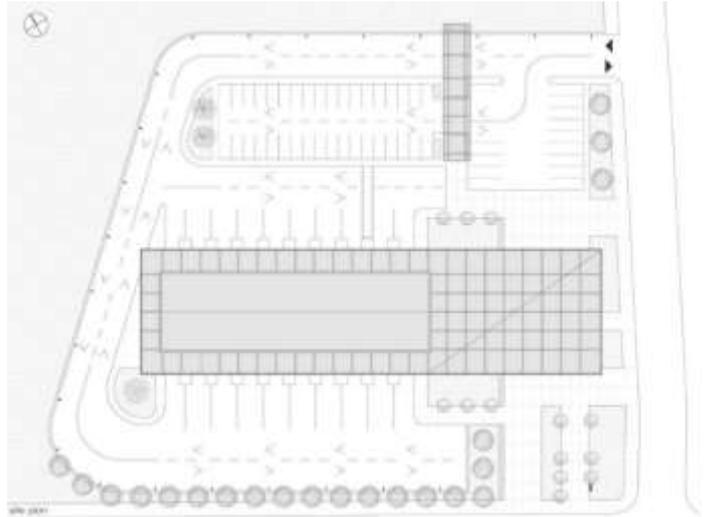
Plot plan de la Estación de Autobuses Lüleburgaz.
